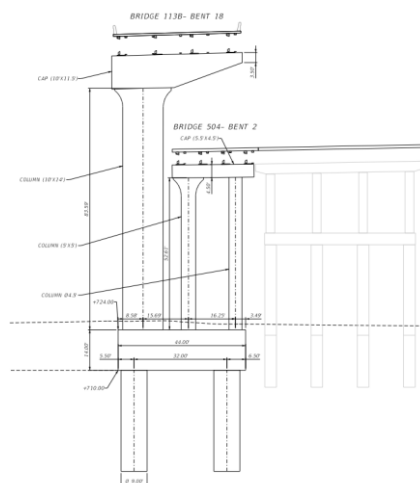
Alzado pila 18, excéntrica, del puente 113B y pila 2 del puente 504.
